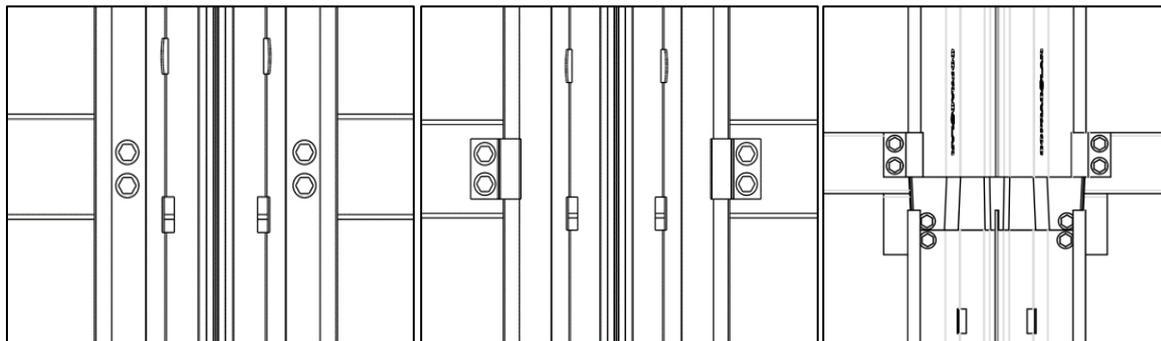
(de gauche à droite) point fixe, point coulissant et fixation d'une éclisse
